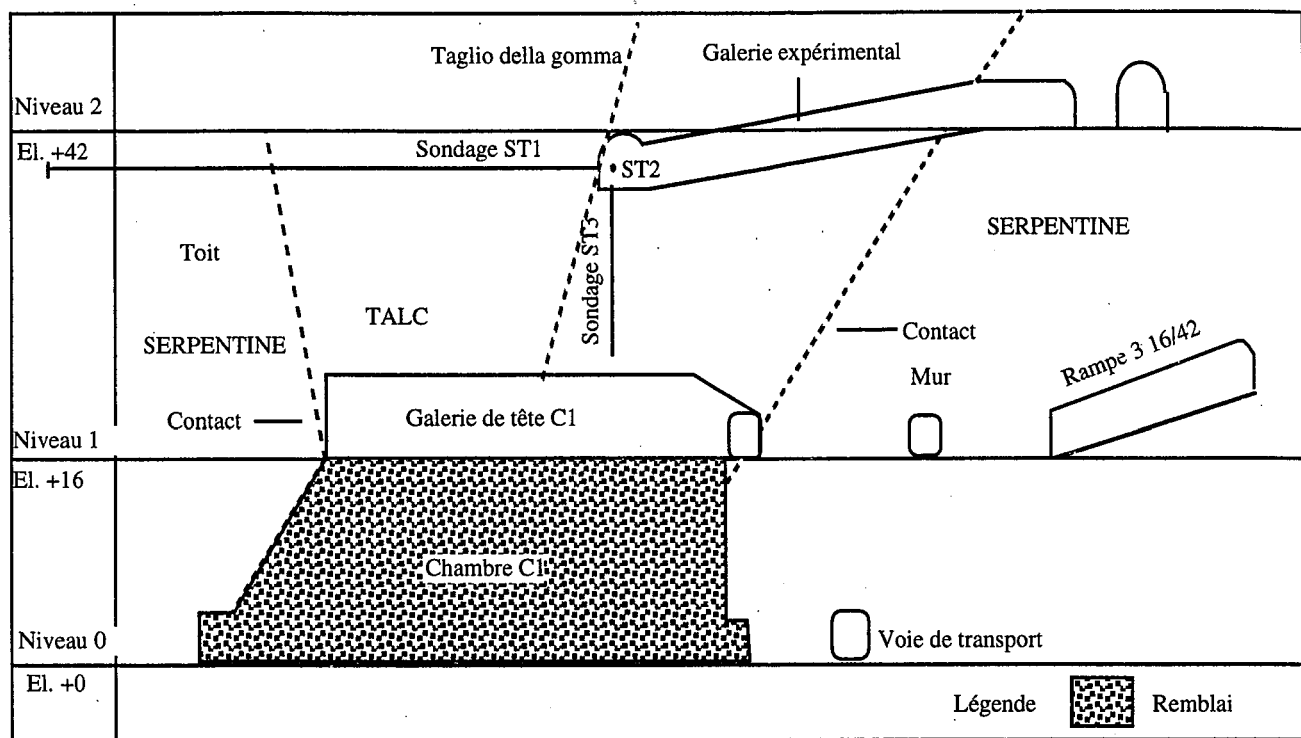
Section verticale parallèle à l'allongement du pilier C5/C6 montrant la galerie expérimentale et les trous de sondage (ST1, ST2 et ST3)
